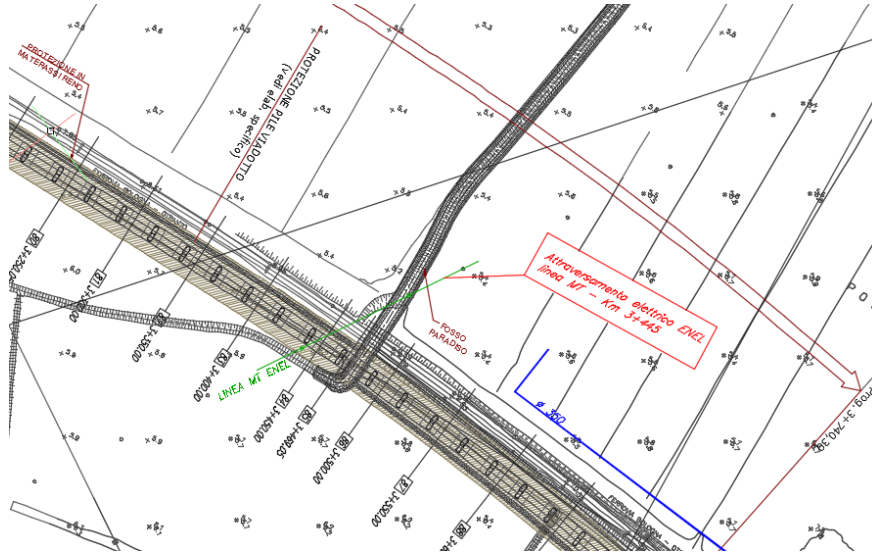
Stralcio planimetrico con individuazione dell'interferenza
